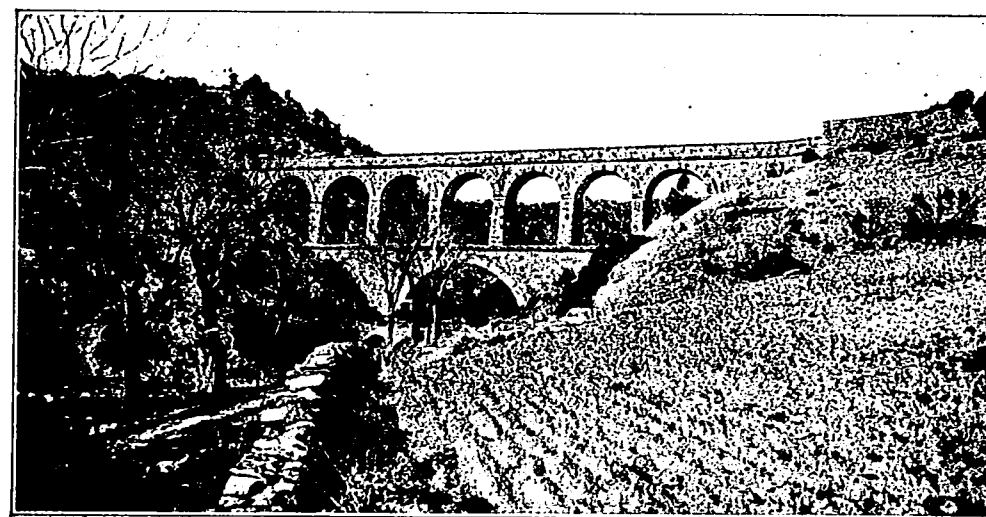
Puente acueducto de la Sima, Kilómetro 34.
